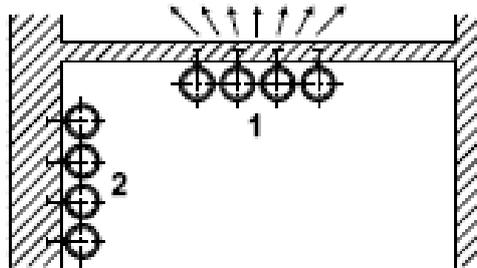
Posizionamento delle tubazioni errato, su parete sottile al centro; corretto, su parete spessa nell'angolo staticamente rinforzato.
